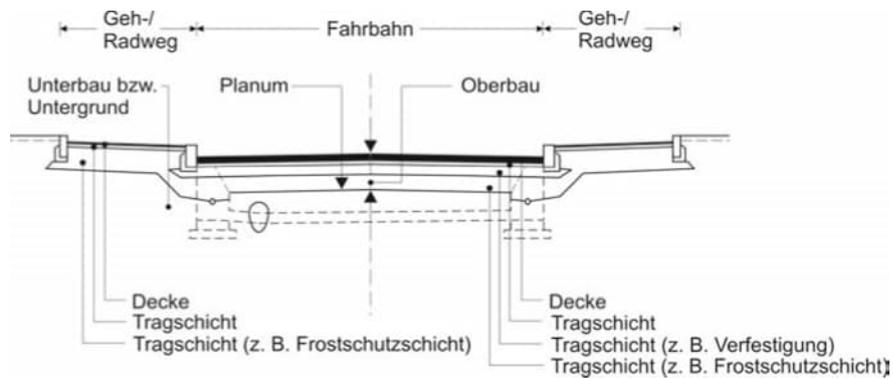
Beispielhafter Aufbau einer Befestigung in geschlossener Ortslage mit teilweise wasserundurchlässigen Randbereichen sowie mit Entwässerungseinrichtungen
